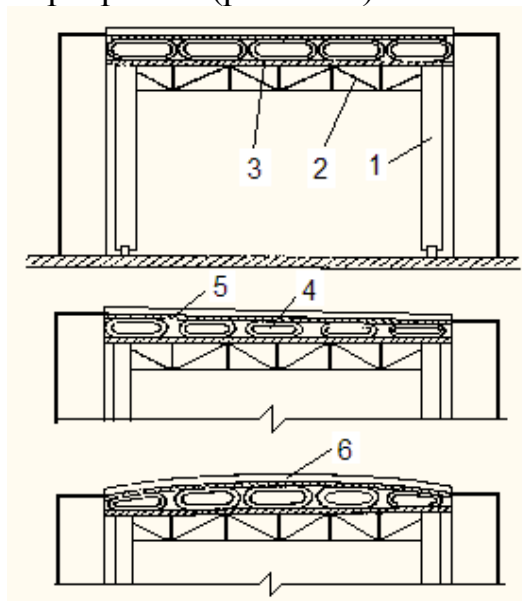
Схема опалубки для бетонирования перекрытий
